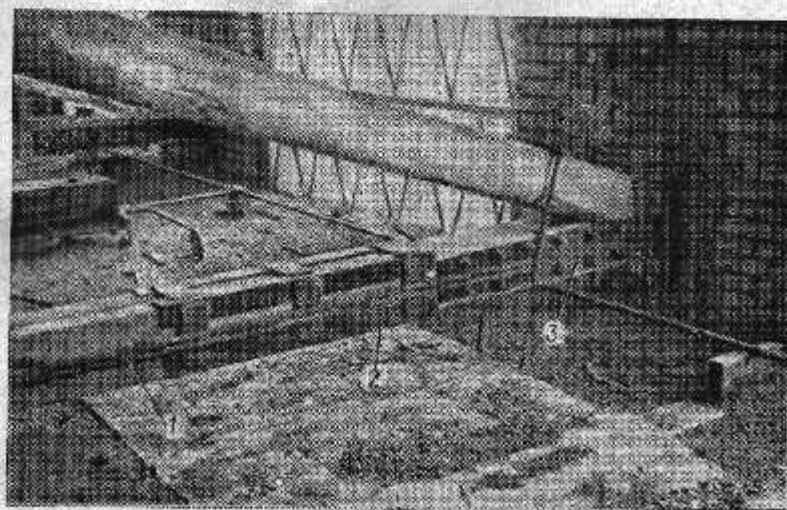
Усиление нижнего пояса треугольной фермы из брусьев
